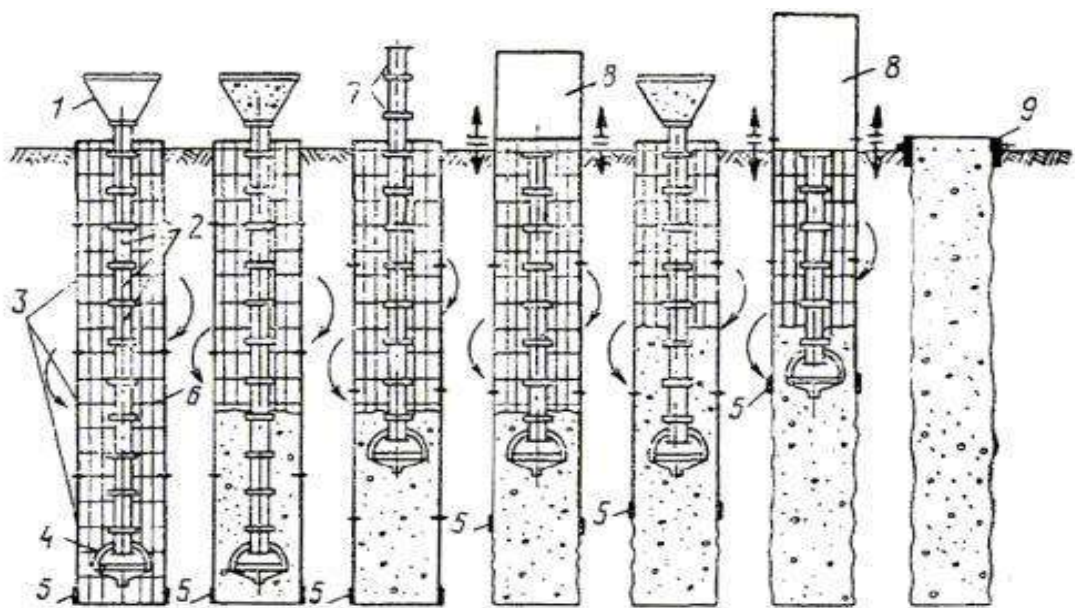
Технологічна схема бетонування буронабивної палі: 1 – вібробаддя (бункер); 2 – обсадана труба; 3 – секції обсадної труби; 4 – прилад контролю ущільнення бетонної суміші; 5 – зрізуюча кромка; 6 – армокаркас; 7 – шнек бурильної установки; 8 – окремі секції обсадної труби; 9 – кондуктор для формування оголовку палі
